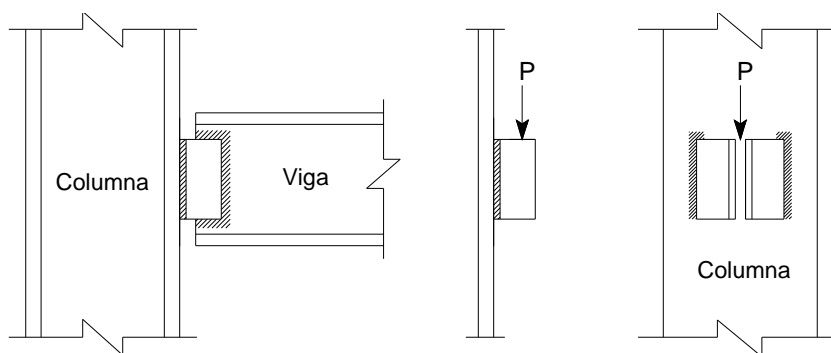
Diseño de soldadura para ángulo de asiento de conexión de ejemplo 8.3
